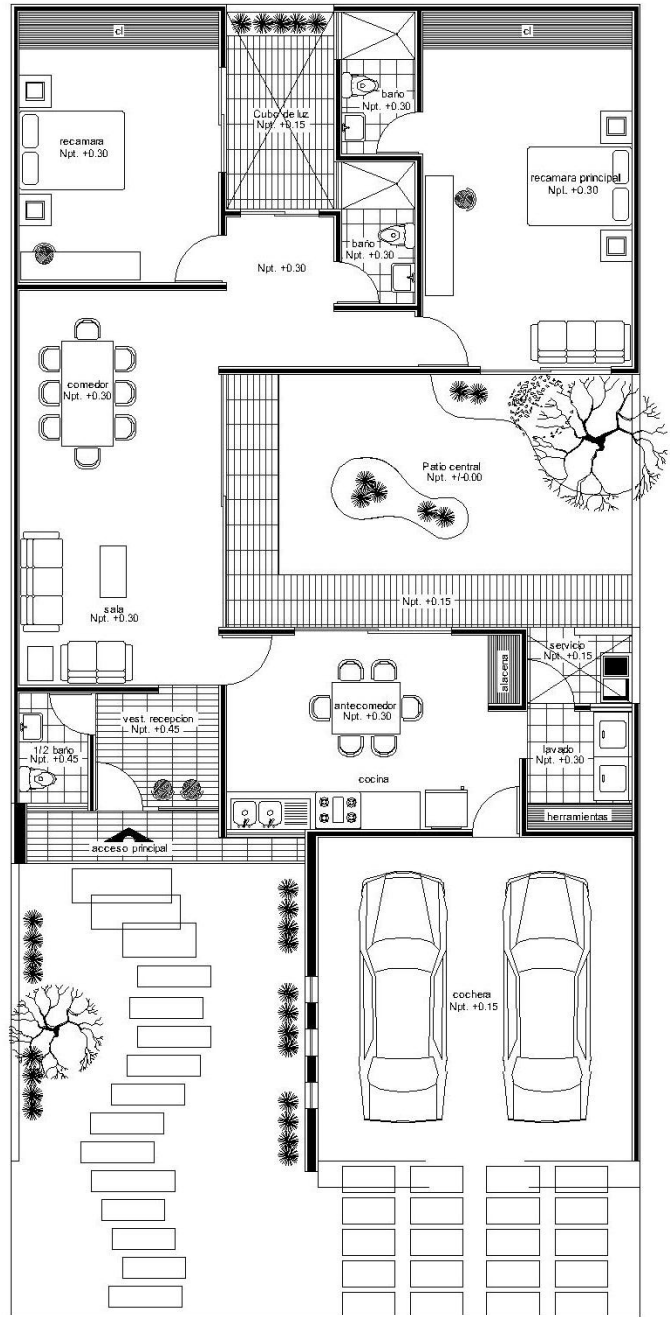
Vivienda de nivel medio con planta en U y patio central. Fuente: Autoría propia, 2014.
